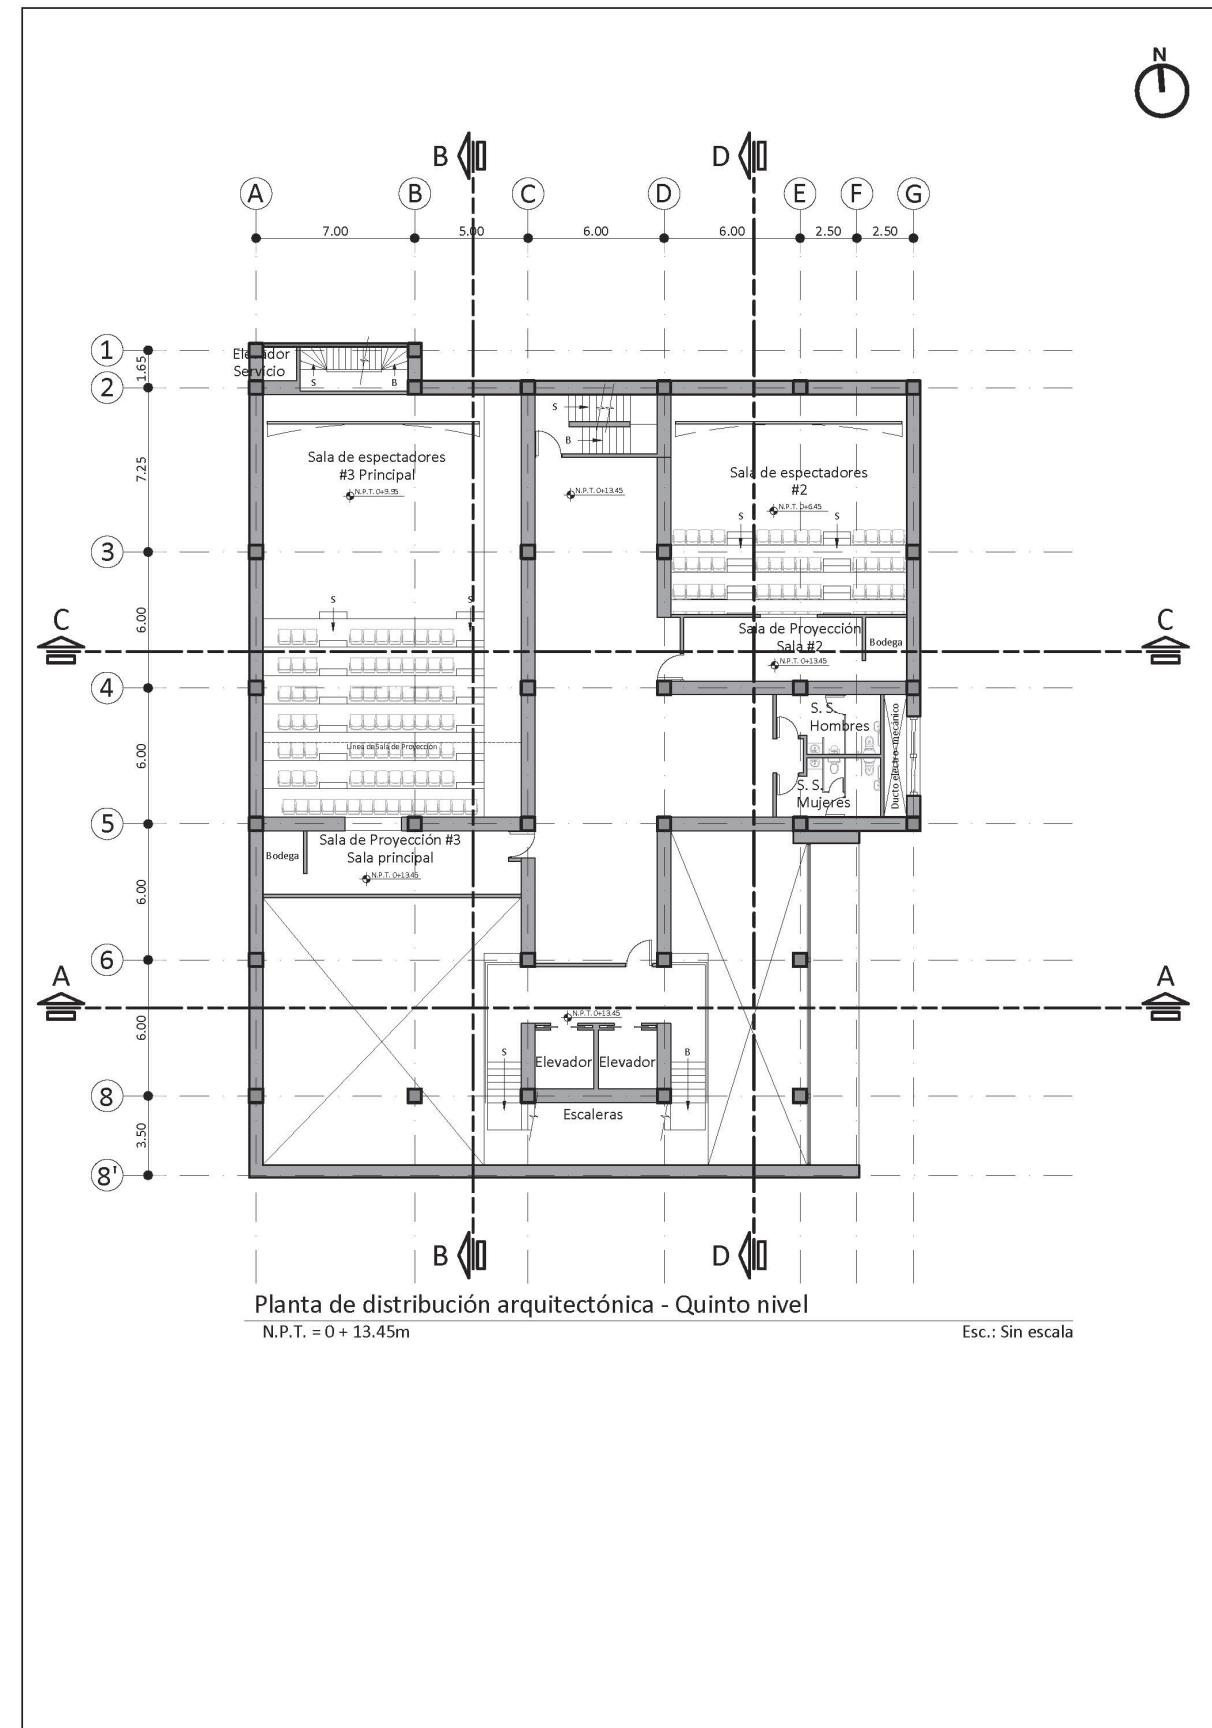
Planta de distribución arquitectónica de quinto nivel. Fuente: Propia.
